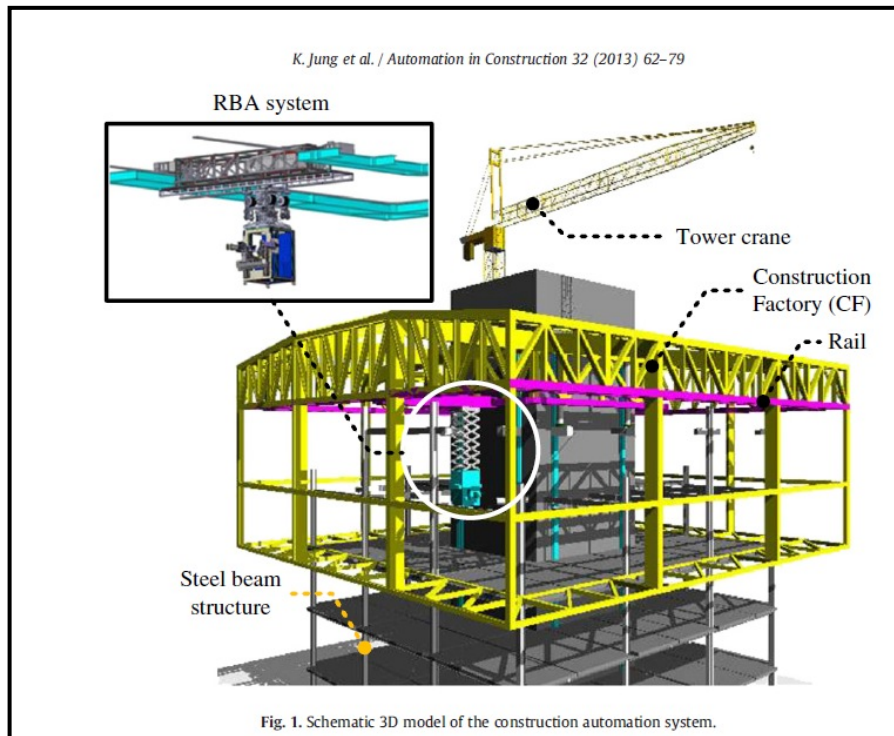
Sistema de transporte robotizado. *Robot-based construction automation:an application to steel beam assembly (Parte II).
